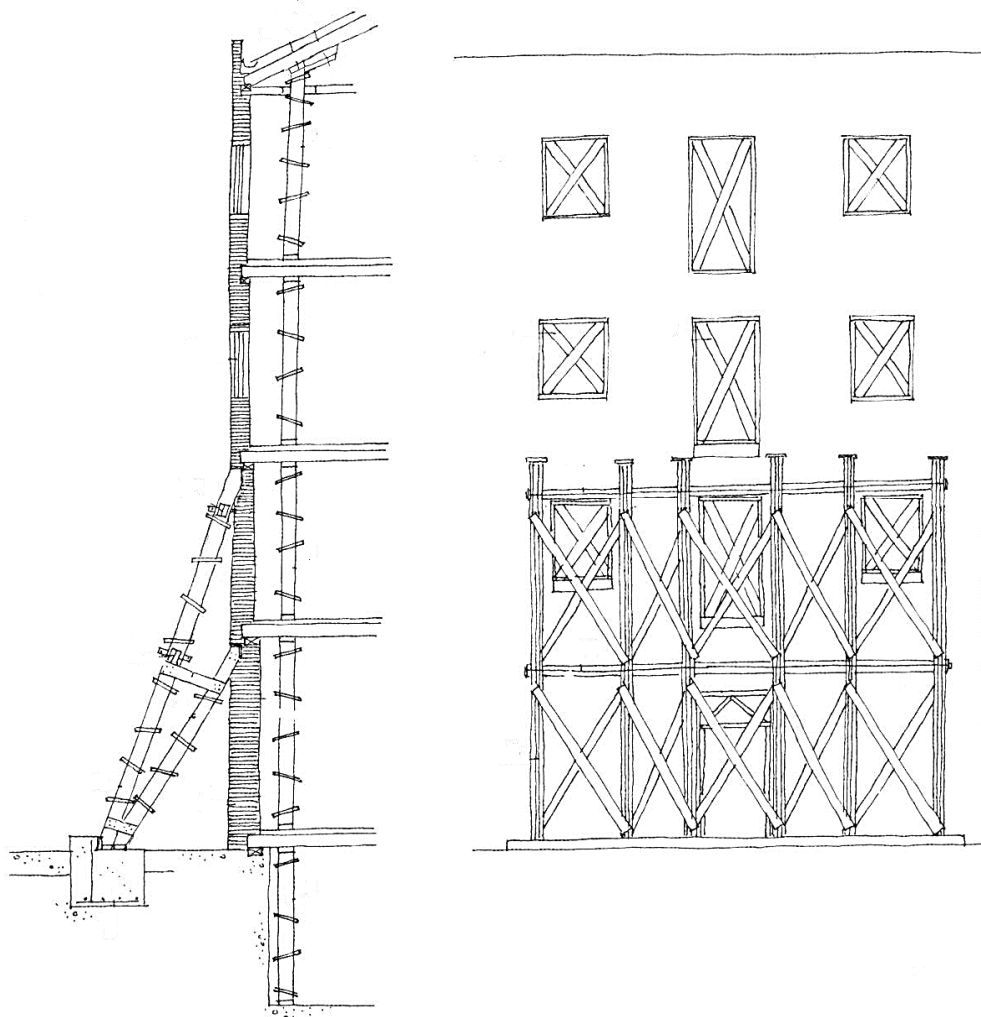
Solución para apeo de muros de más de 2 plantas
